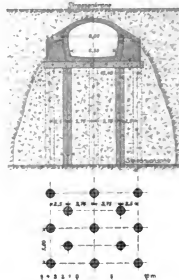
Tunnel über einem Steinbruch mit eingestürzter Decke. — Massstab 1:500.
